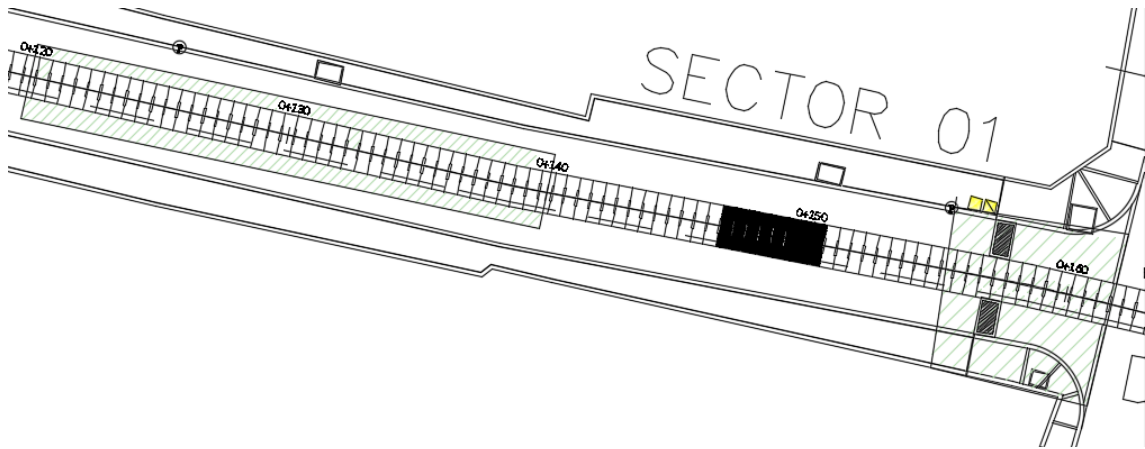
Plano en planta del SECTOR 01 del Jr. Bellido.
